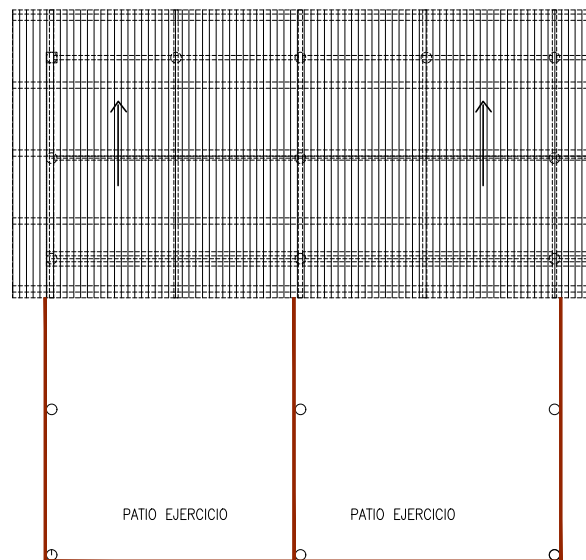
Planta arquitectura, estructura y cubiertas Escala: 1/100
